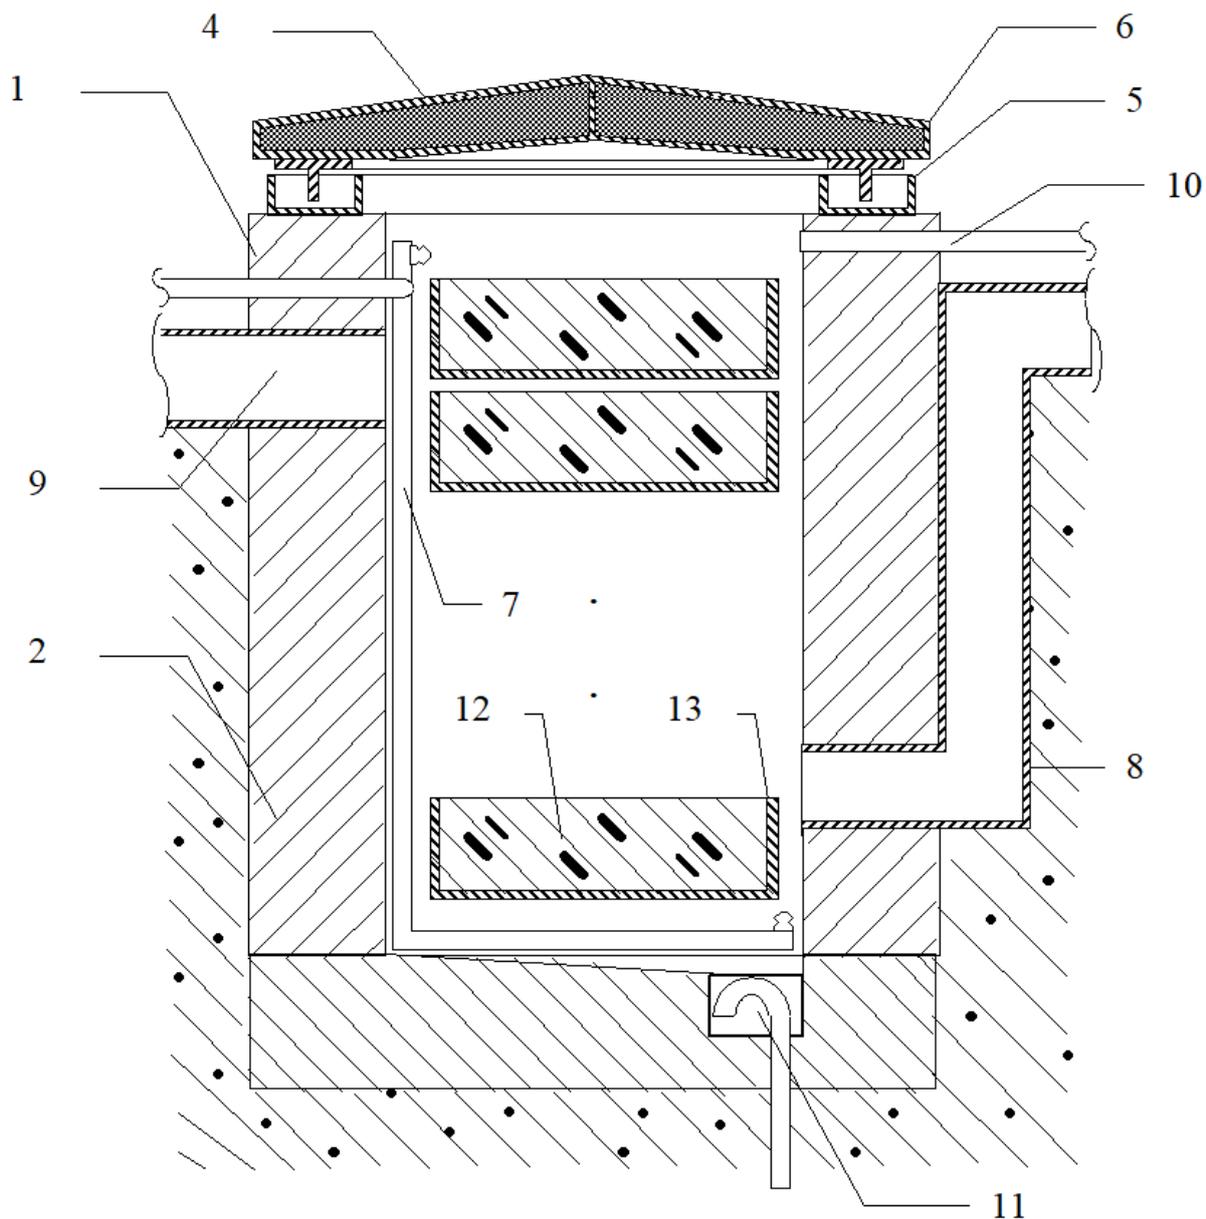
Общий вид пропарочной камеры ямного типа:
